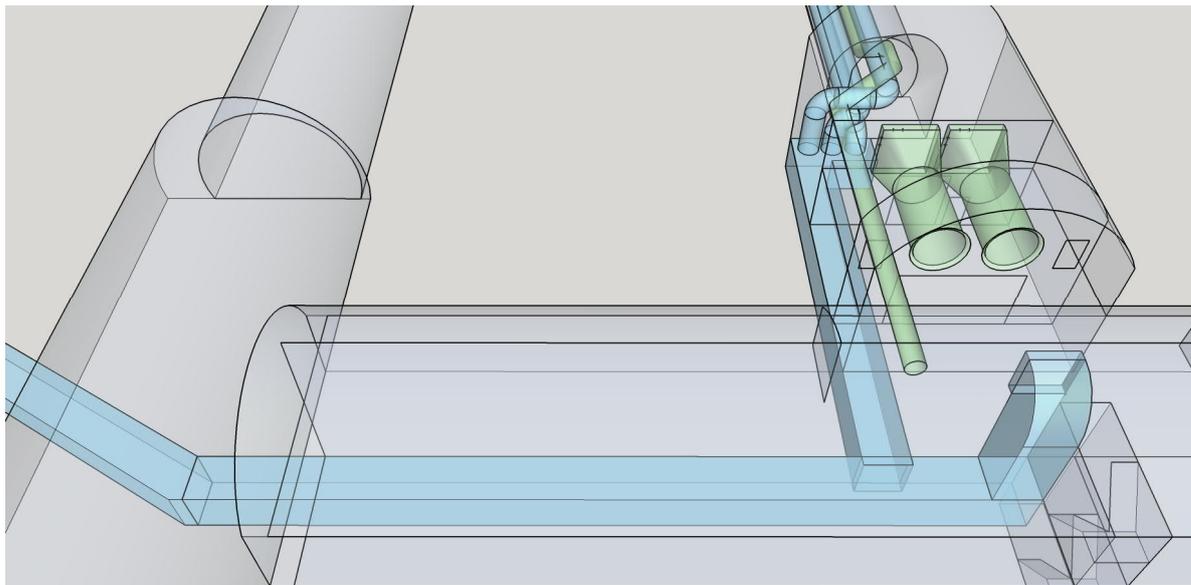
Configuración del canal de ventilación y bypass en la central Oeste.
